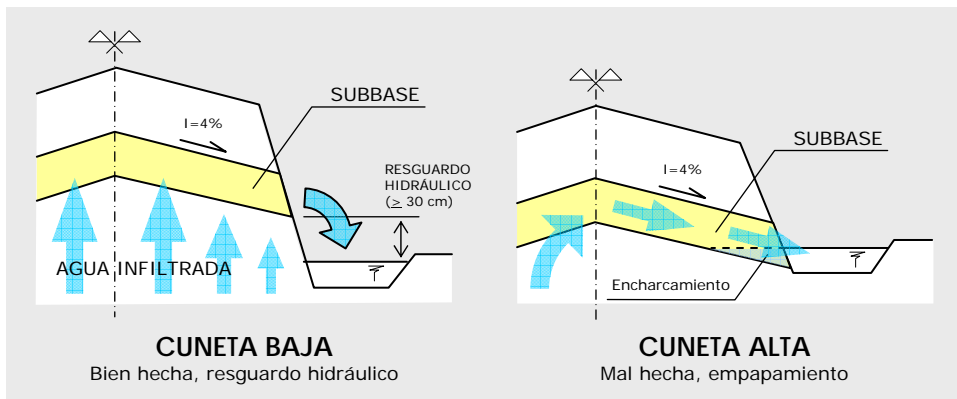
Conexión entre la capa subbase y el drenaje superficial
